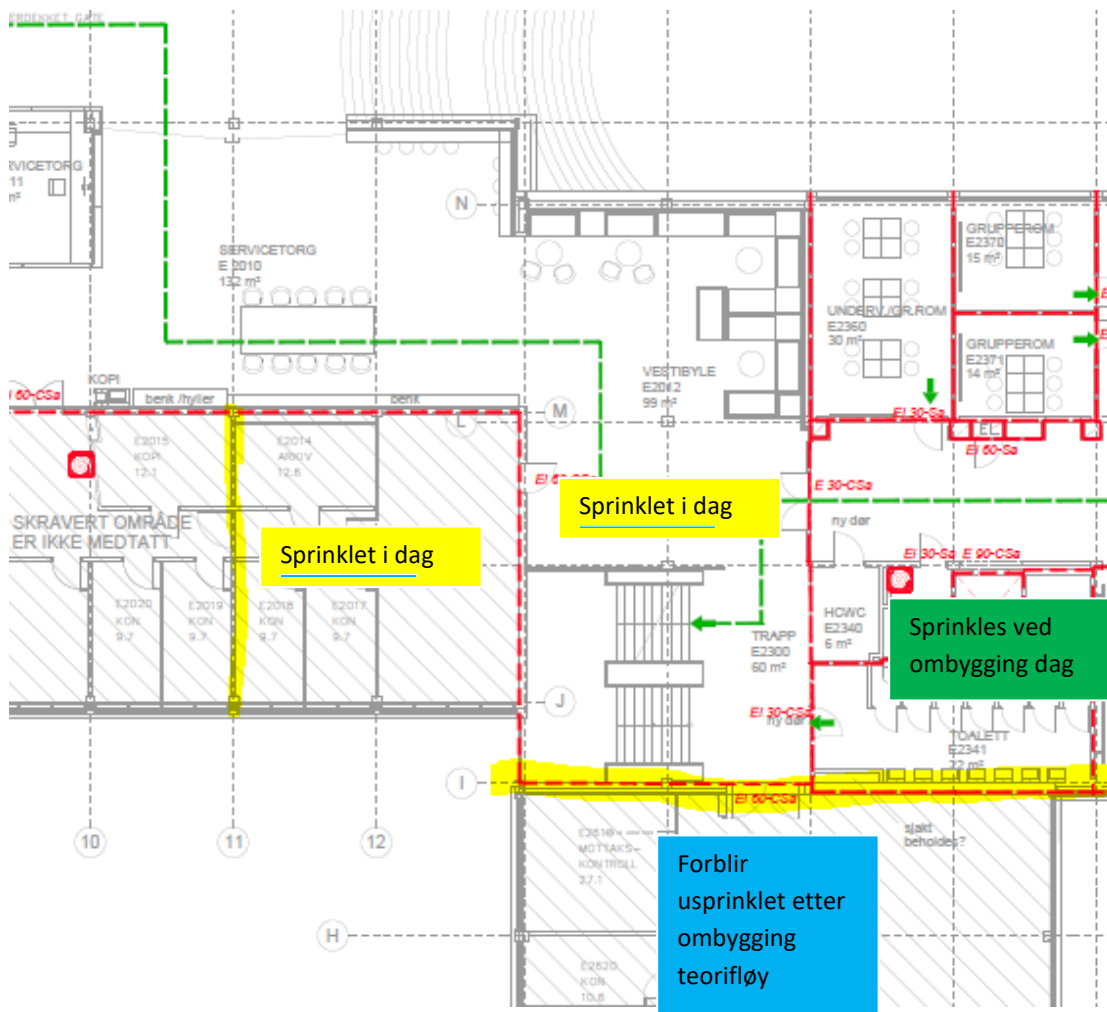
Ny situasjon plan 2 med sprinklede områder markert.
